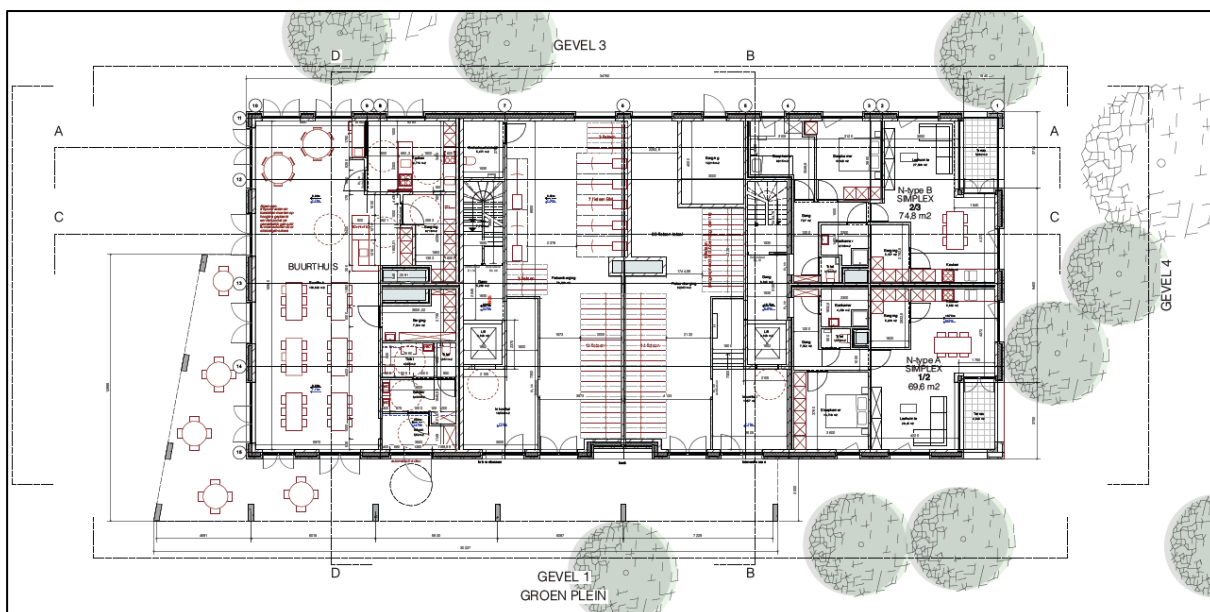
Detail inplantingsplan zone noord.¹⁰
